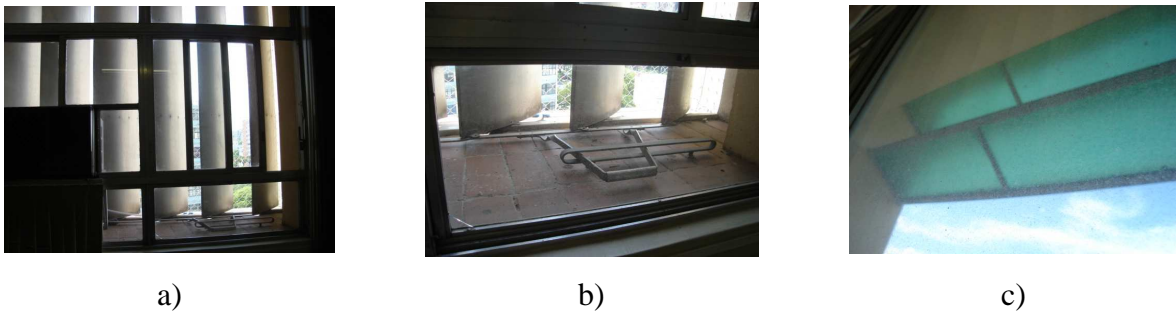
Fotos internas dos brises, a) brise vertical, b) mecanismo, c) brise horizontal
